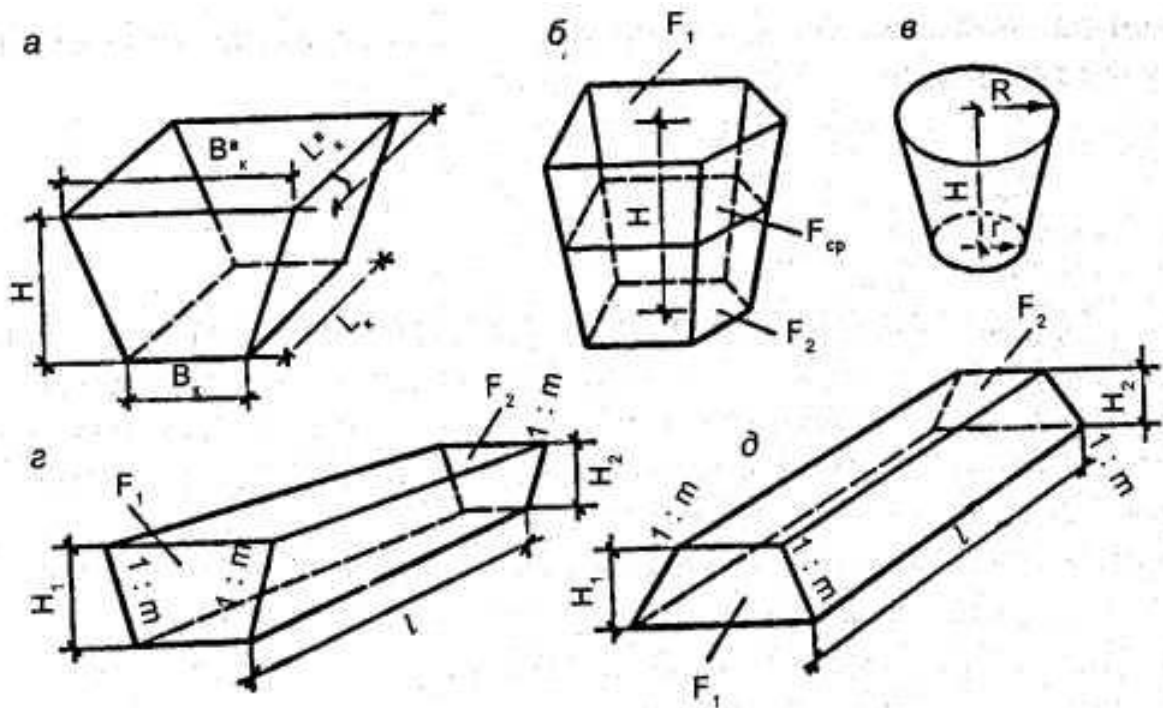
Схема для определения объёмов земляных работ при устройстве котлованов различной формы, траншей, насыпей:
